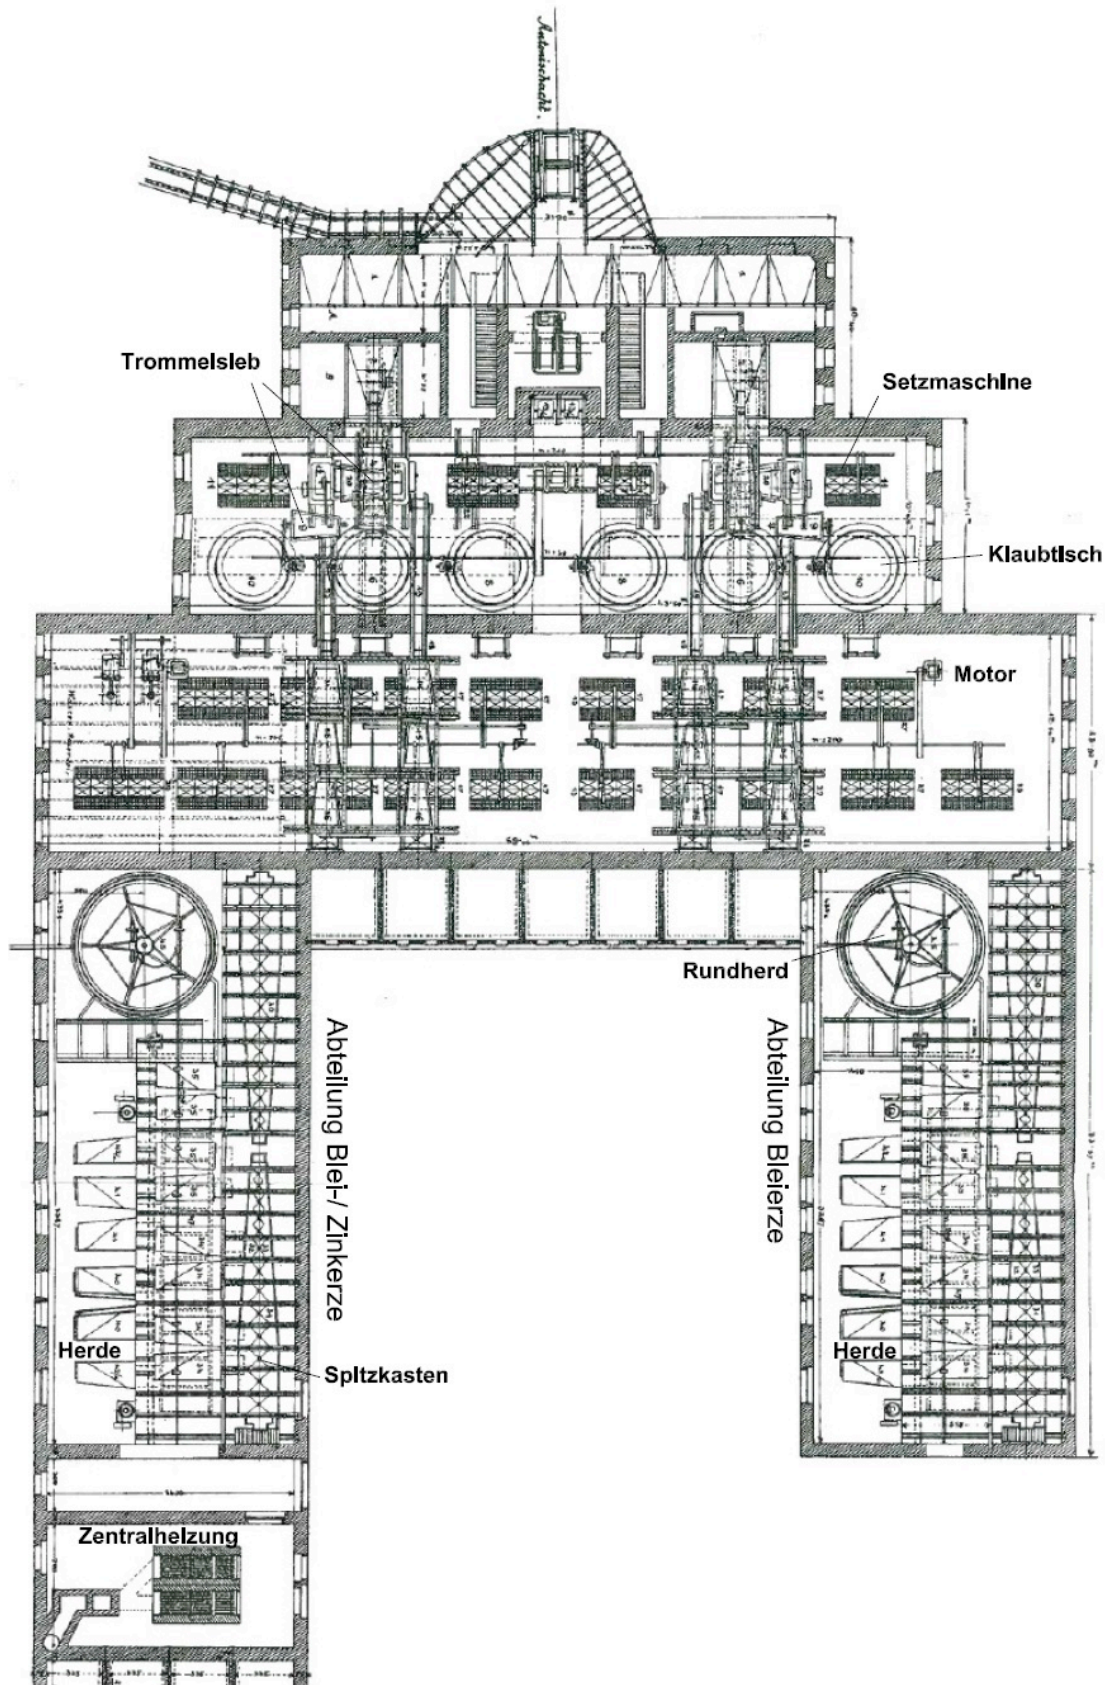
Grundriss der Aufbereitungsanlage Antonischacht von 1911 (nach Neuburger, 1911)¹²
